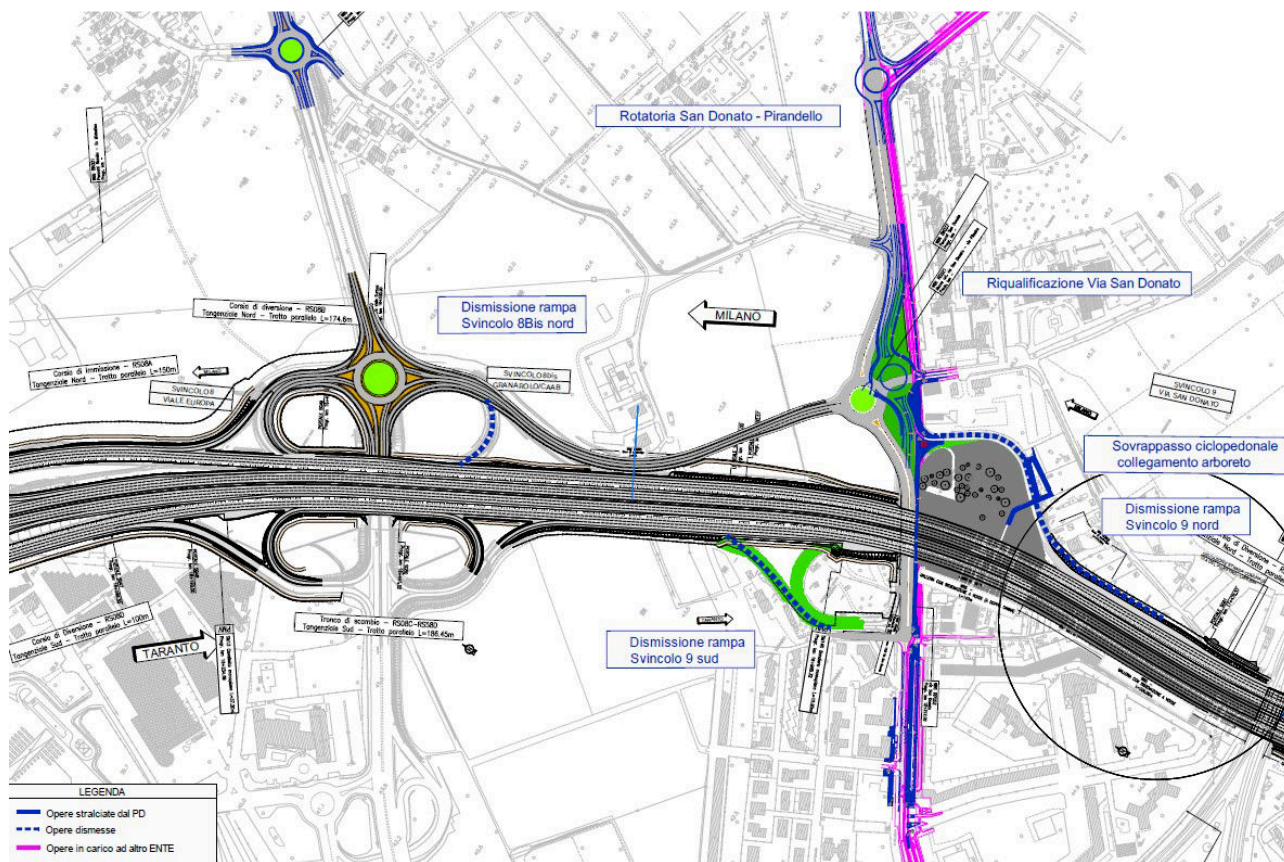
Planimetria progetto di chiusura totale e realizzazione nuova bretella (Fonte: Tavola 2)
